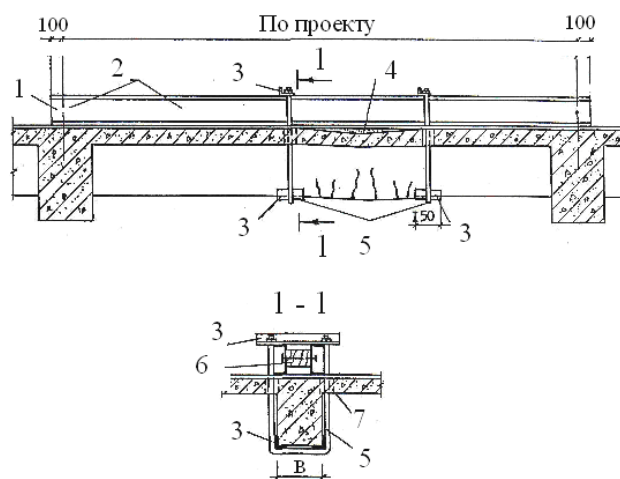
Восстановление второстепенной железобетонной балки путем подвешивания ее к металлической балке:
